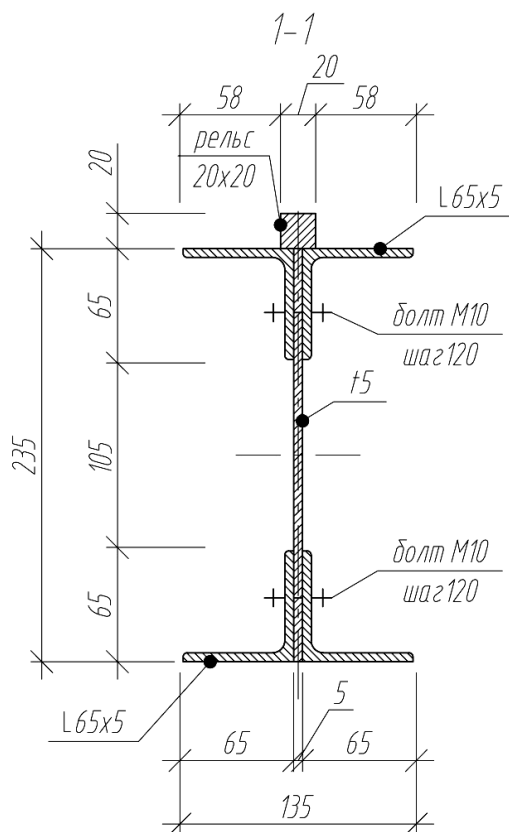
Профиль испытываемой сборной подкрановой балки БК
